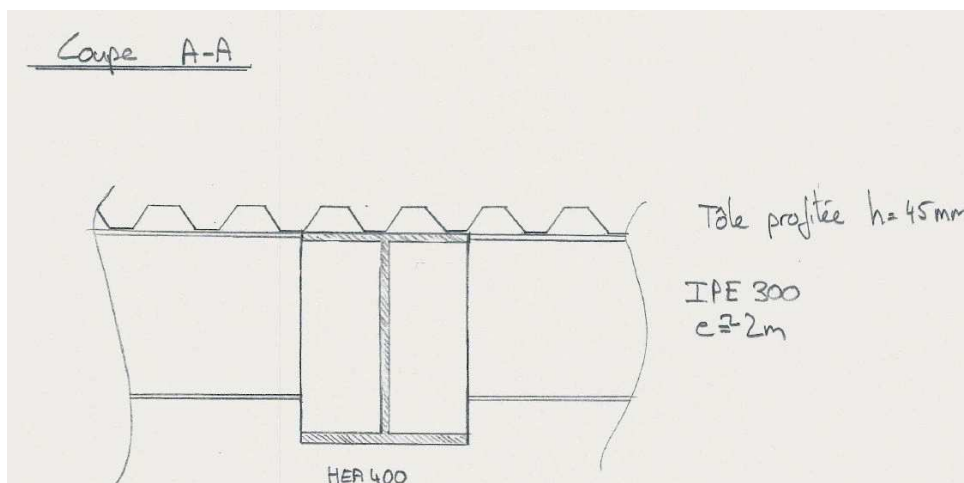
Proposition pour la surélévation en construction métallique du corps central - coupe A-A (voir figure 7.4)
